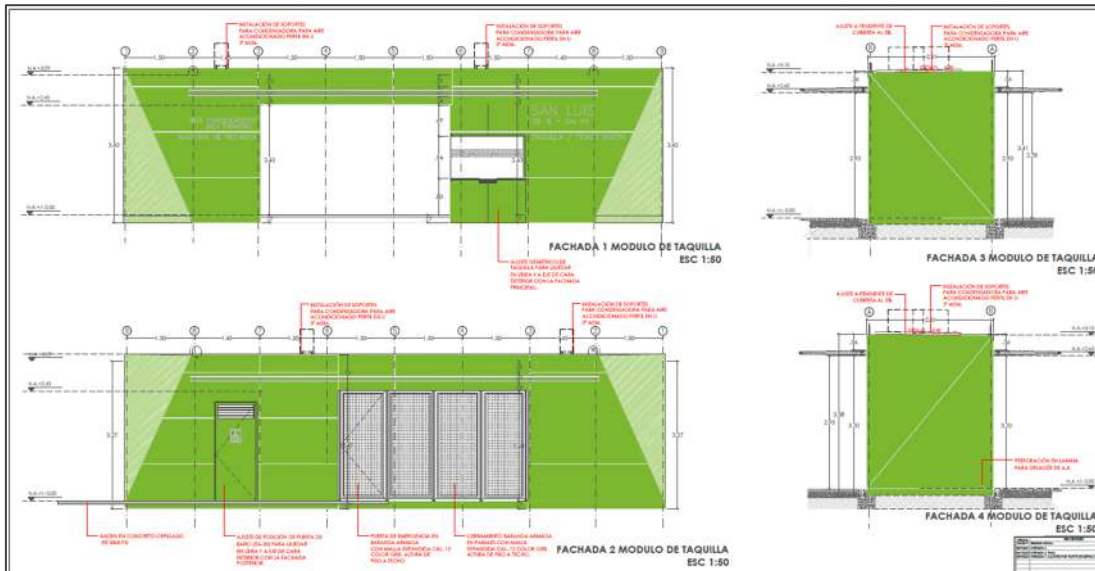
Localización de los puntos de sujeción para de controladoras de aire acondicionado. Plano 7. A-201 FACHADA 1-2-3-4 TAQUILLA-A-201 FACHADAS 1 - 2 -3 -4.dwg.
